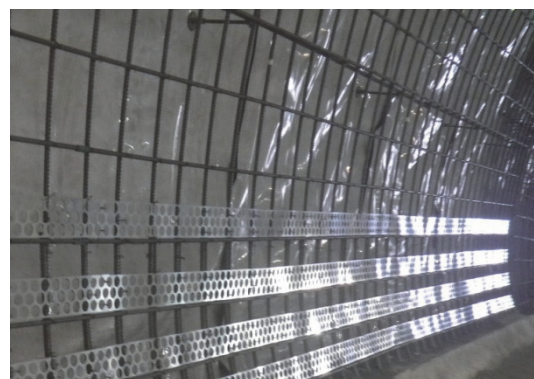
覆工コンクリートへの適用例 (有筋区間)
